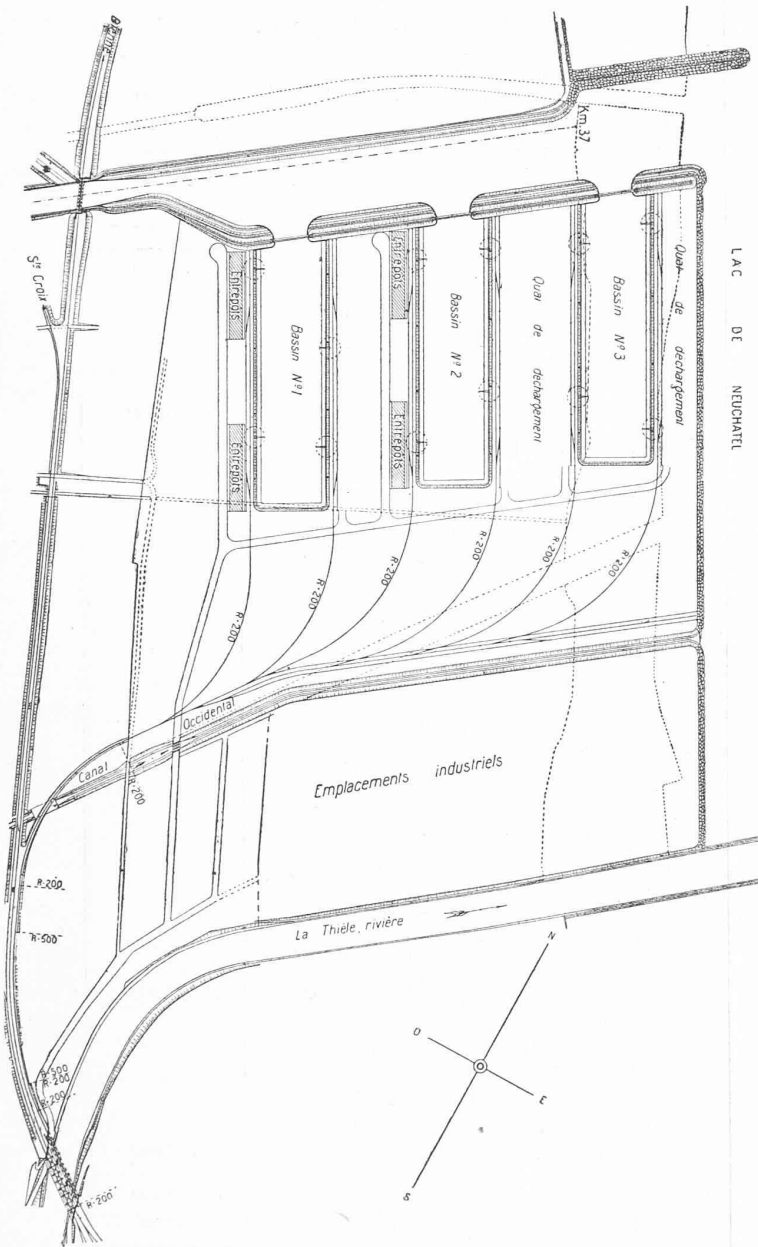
Plan du port d'Yverdon — 1 : 8000.
